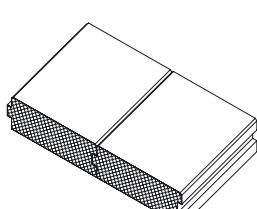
Strop z betonskimi rebri in lahkim polnilom.
